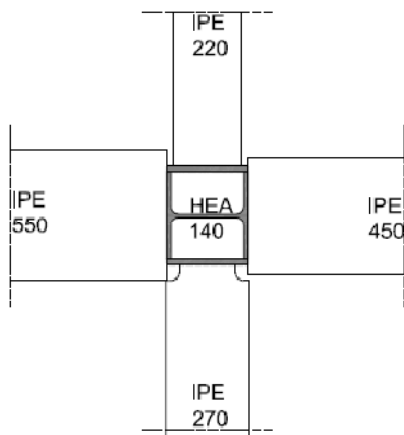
Connessione tra travi e pilastro mediante utilizzo di fazzoletti
